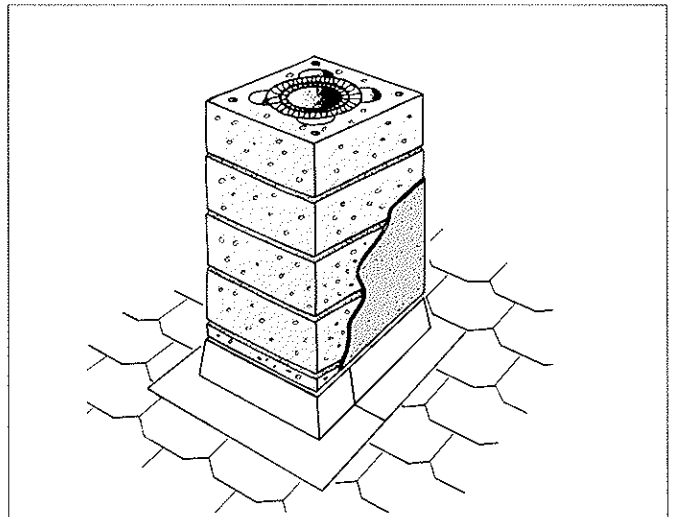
Pipebeslag tilpasset for flatt takbelegg (papp, shingel m.m). Beslaget er teleskopisk, kan anvendes kun på pusset ettløps pipe.
